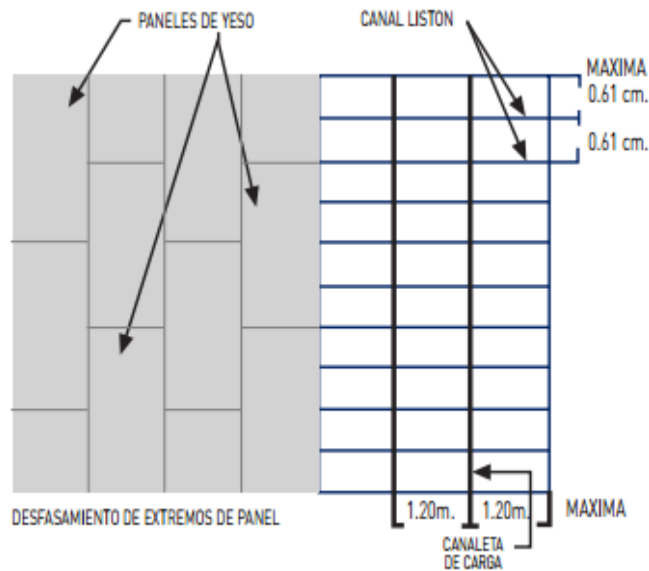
Separación de retícula de carga y juntas de un plafón de panel de yeso (REY, 2016).
